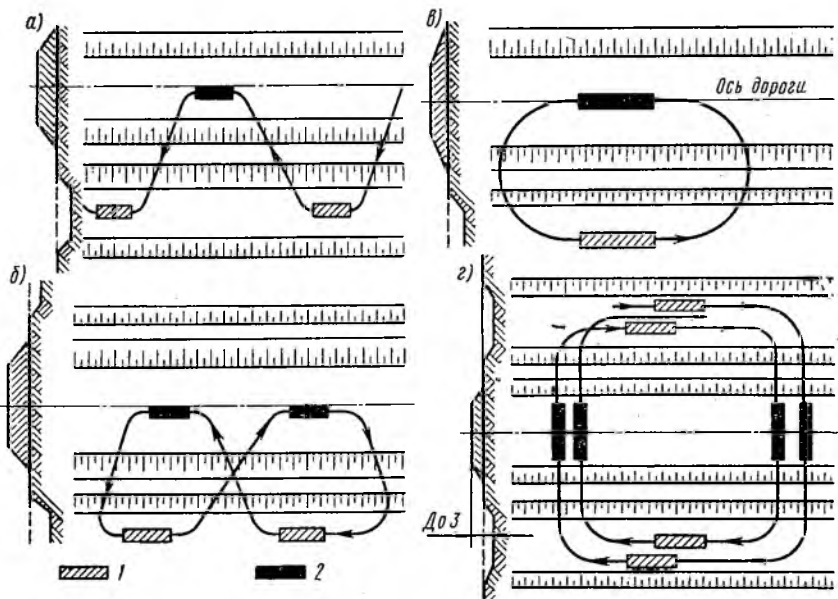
Схемы движения скреперов при разработке грунта и перемещении грунта в насыпь:
